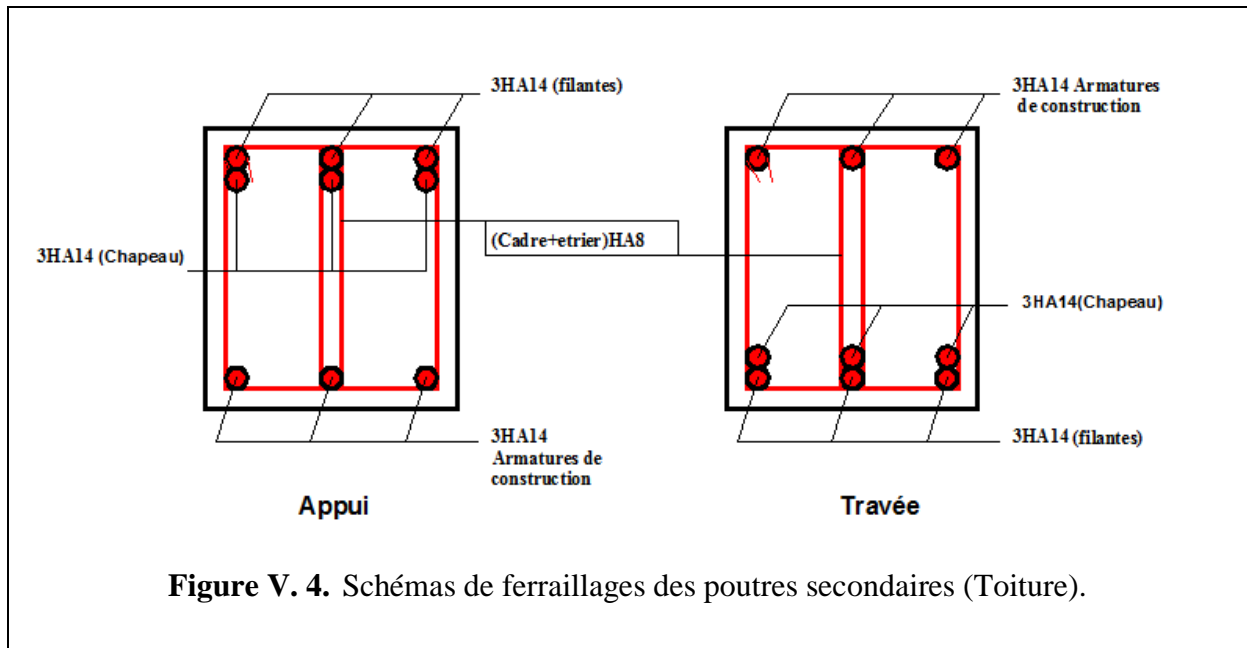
Schémas de ferrailages des poutres secondaires (Toiture).
